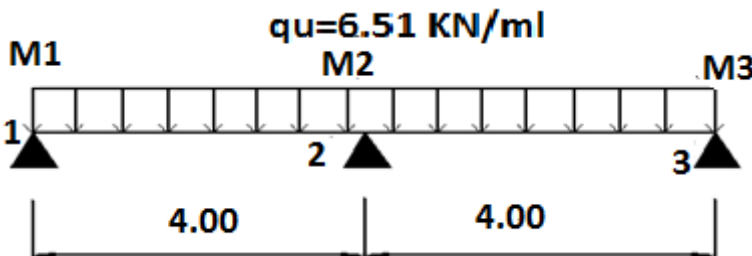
schéma statique de la poutrelle type 1 à l'ELU
